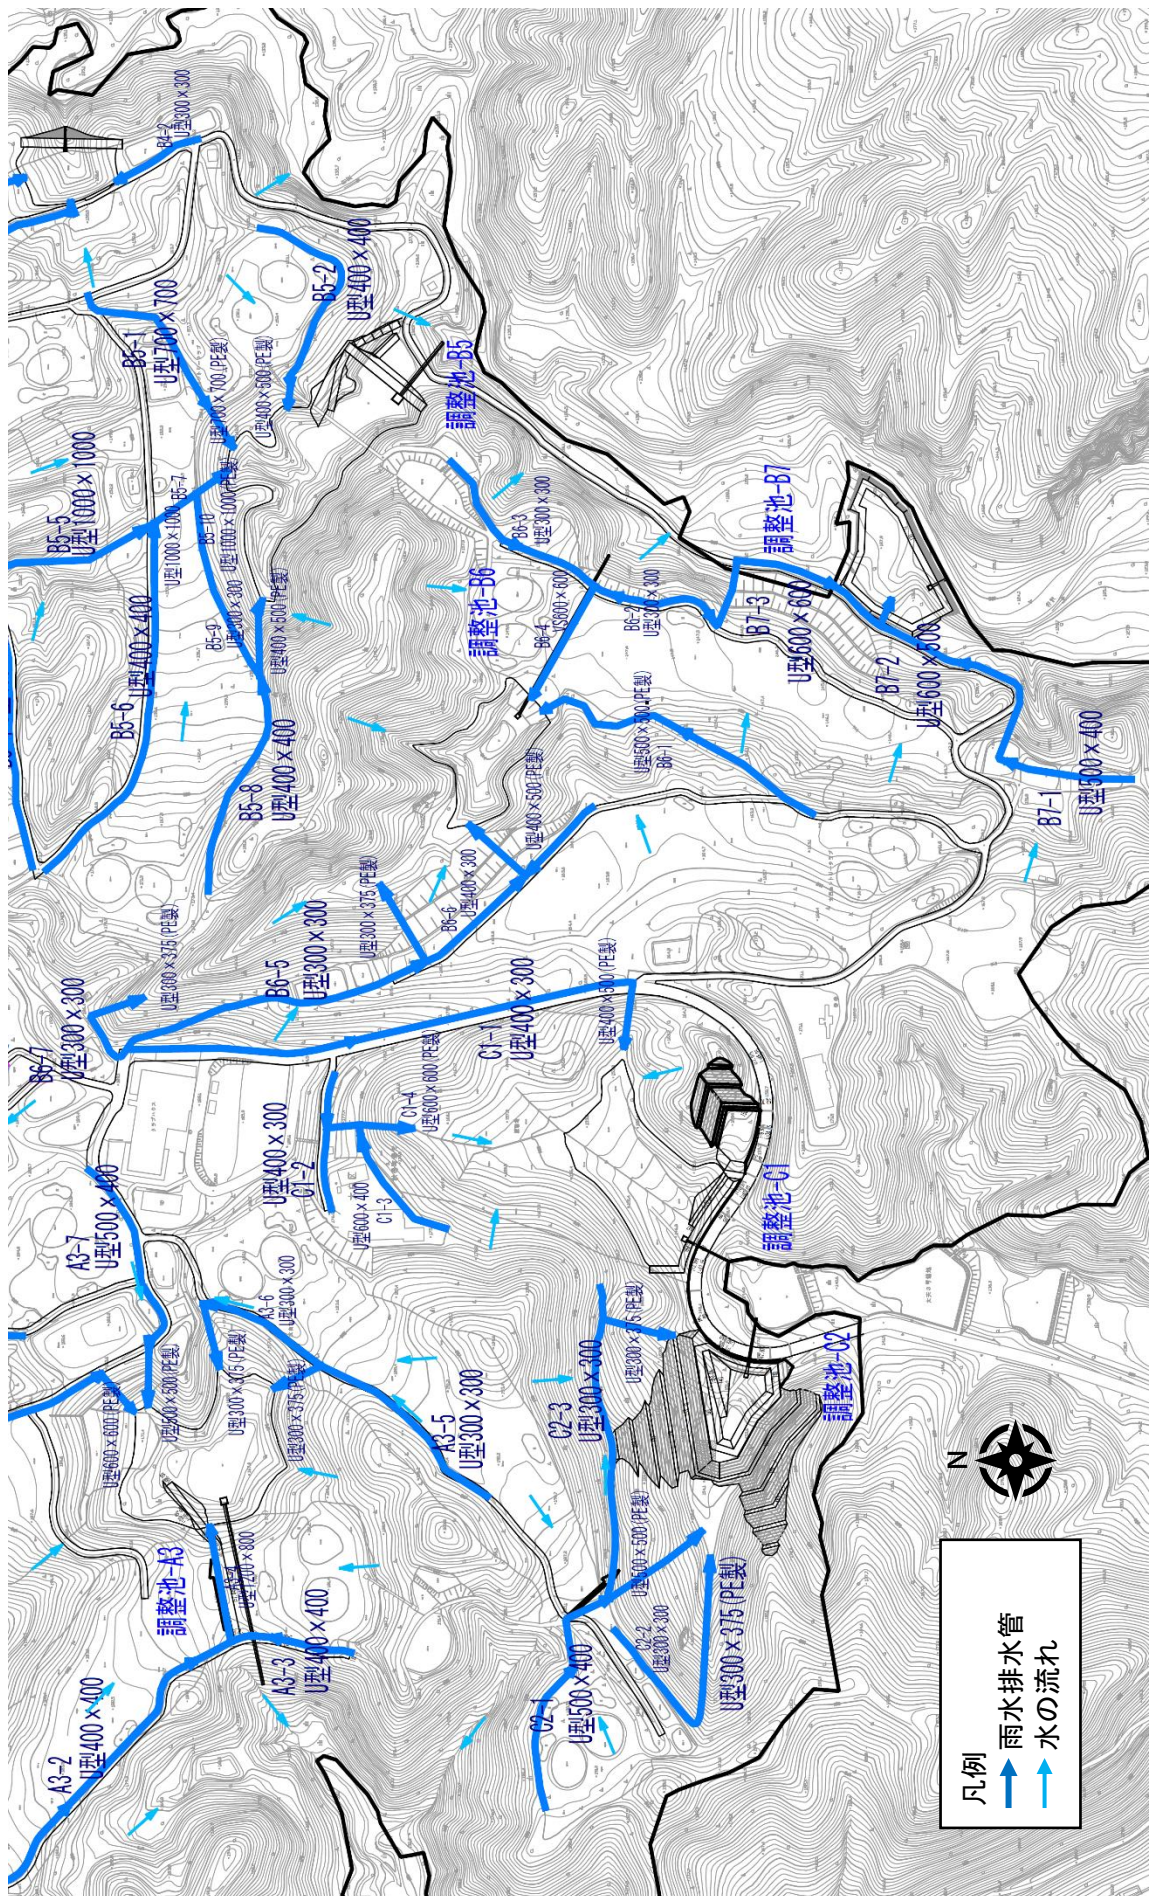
雨水排水施設平面図 (対象事業実施区域 南)
